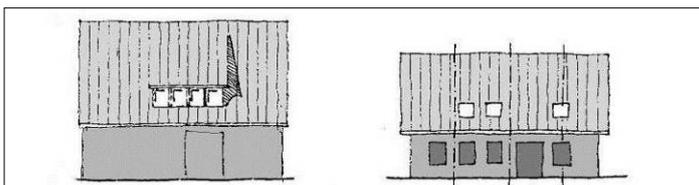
angemessene Gaubengröße und auf die Fassade abgestimmte Anordnung von Dachflächenfenstern
